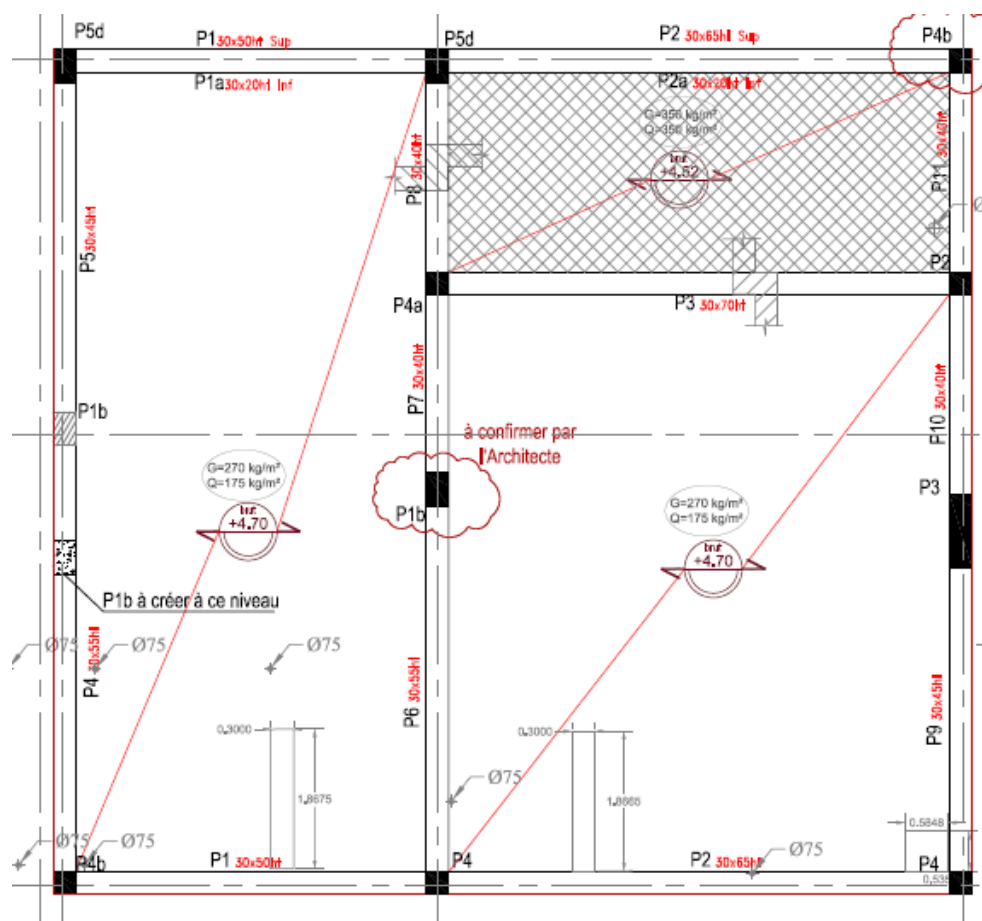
PLAN DE COFFRAGE DALLE PLEINE JOINT 23 PH RDC
